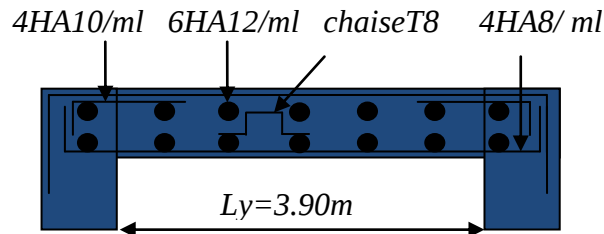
Schéma de ferrailage de la dalle pleine Sur trois appuis
